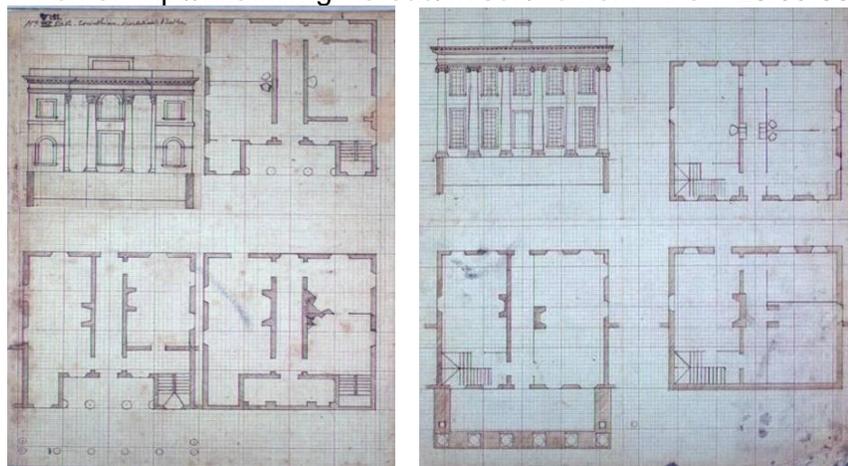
Pavilhão 5; Fig.: 94 - Pavilhão 6
